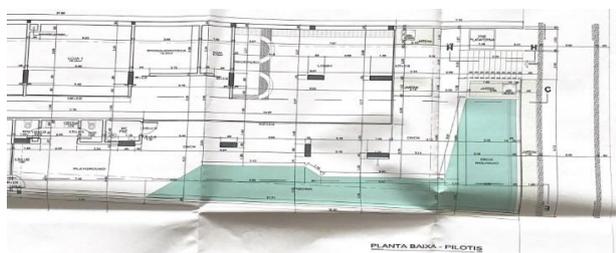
Foto de trecho da planta baixa dos pilotis do Hotel B.
